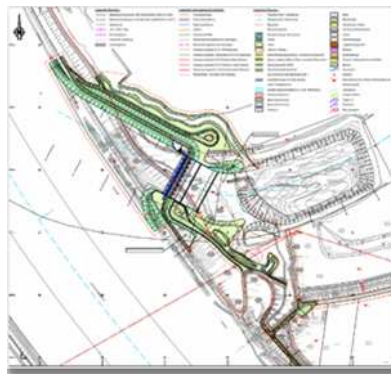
Lageplan Einlaufbauwerk, Arbeitsstand Entwurfsplanung (INGE LLK 2020)
